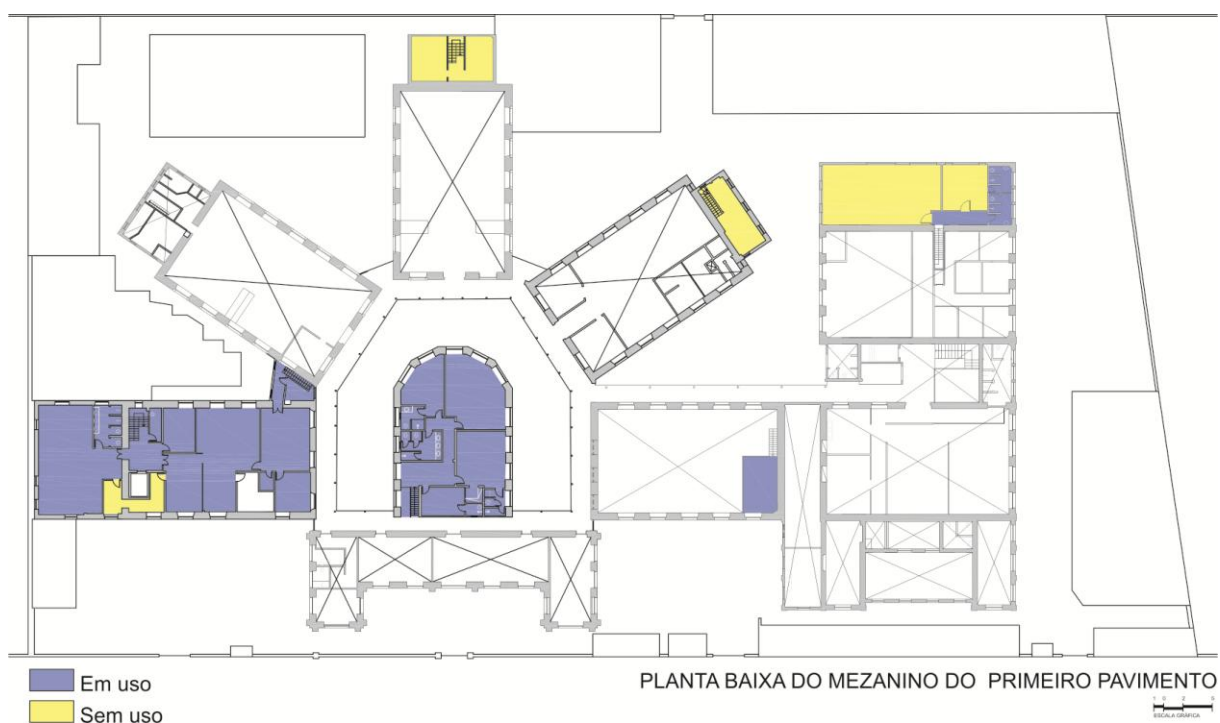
Planta Baixa do Mezanino do Primeiro Pavimento – Ocupação. Fonte: Plano Diretor, 2004.
